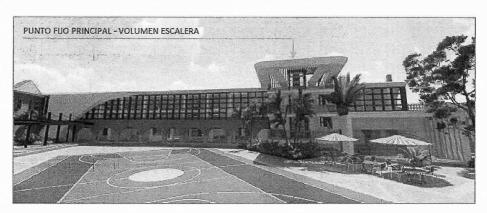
Planteamiento general de la Propuesta de intervención del Bloque de Aulas sector norte y Render de la Fachada interna del bloque de aulas sector norte hacia el patio principal, donde se aprecia la conservación del muro pórtico galería de arcadas de medio punto a nivel de la primera planta y todo el despliegue formal, estético y bioclimático de los elementos que lo complementan como parte de la propuesta, entre ellas el volumen de la escalera principal. Fuente: DP. Construarquitect SAS.
